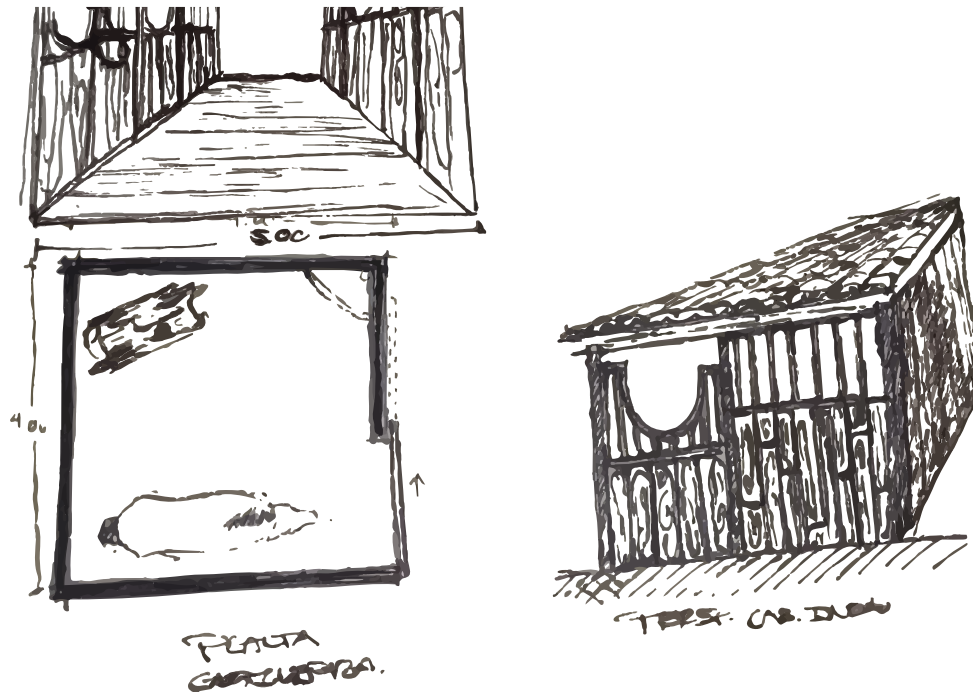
Croquis de caballeriza en planta y alzado. Elaboración propia
